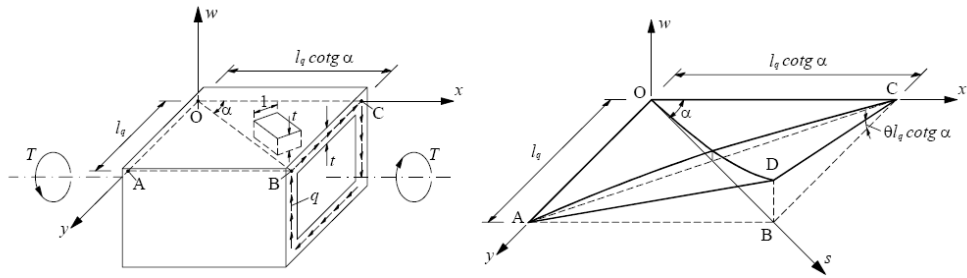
Flexão de uma escora de betão na parede de uma viga em caixão sujeita à torção [13] [7]
